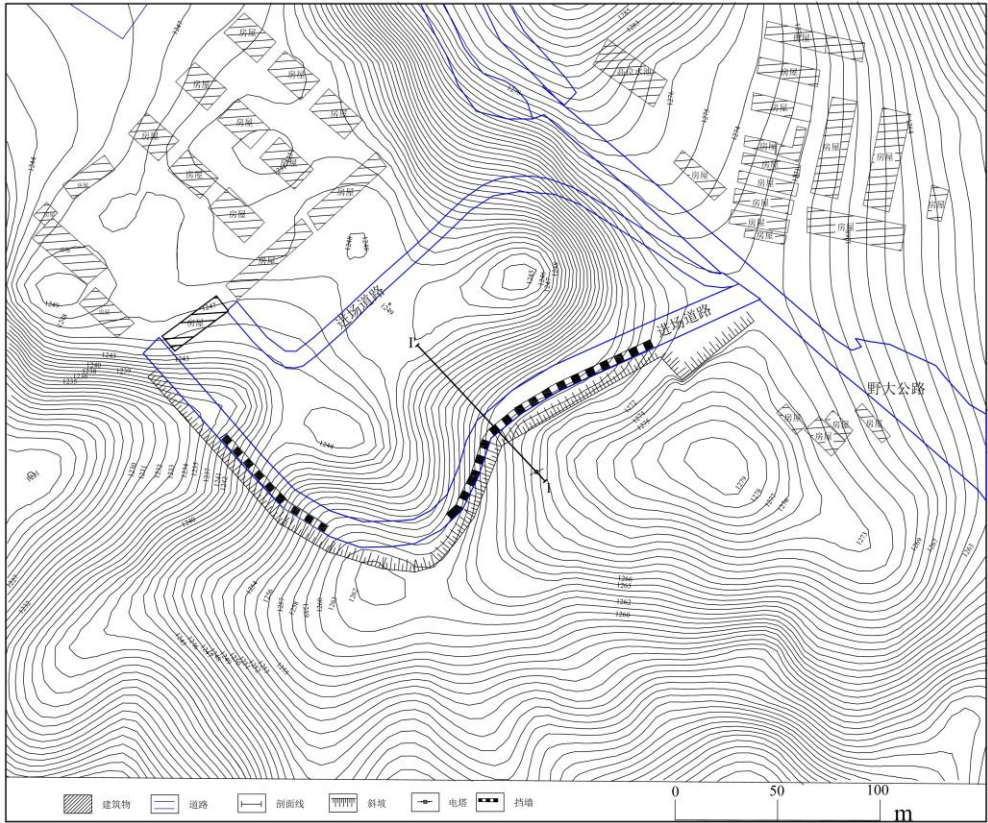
不稳定斜坡 BP1 治理工程平面图
